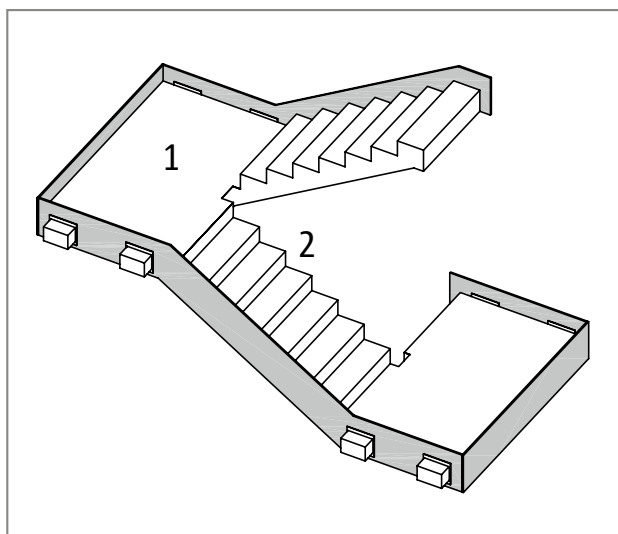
Raffigurazione secondo EN ISO 12354-2 di un pianerottolo separato dalle pareti
